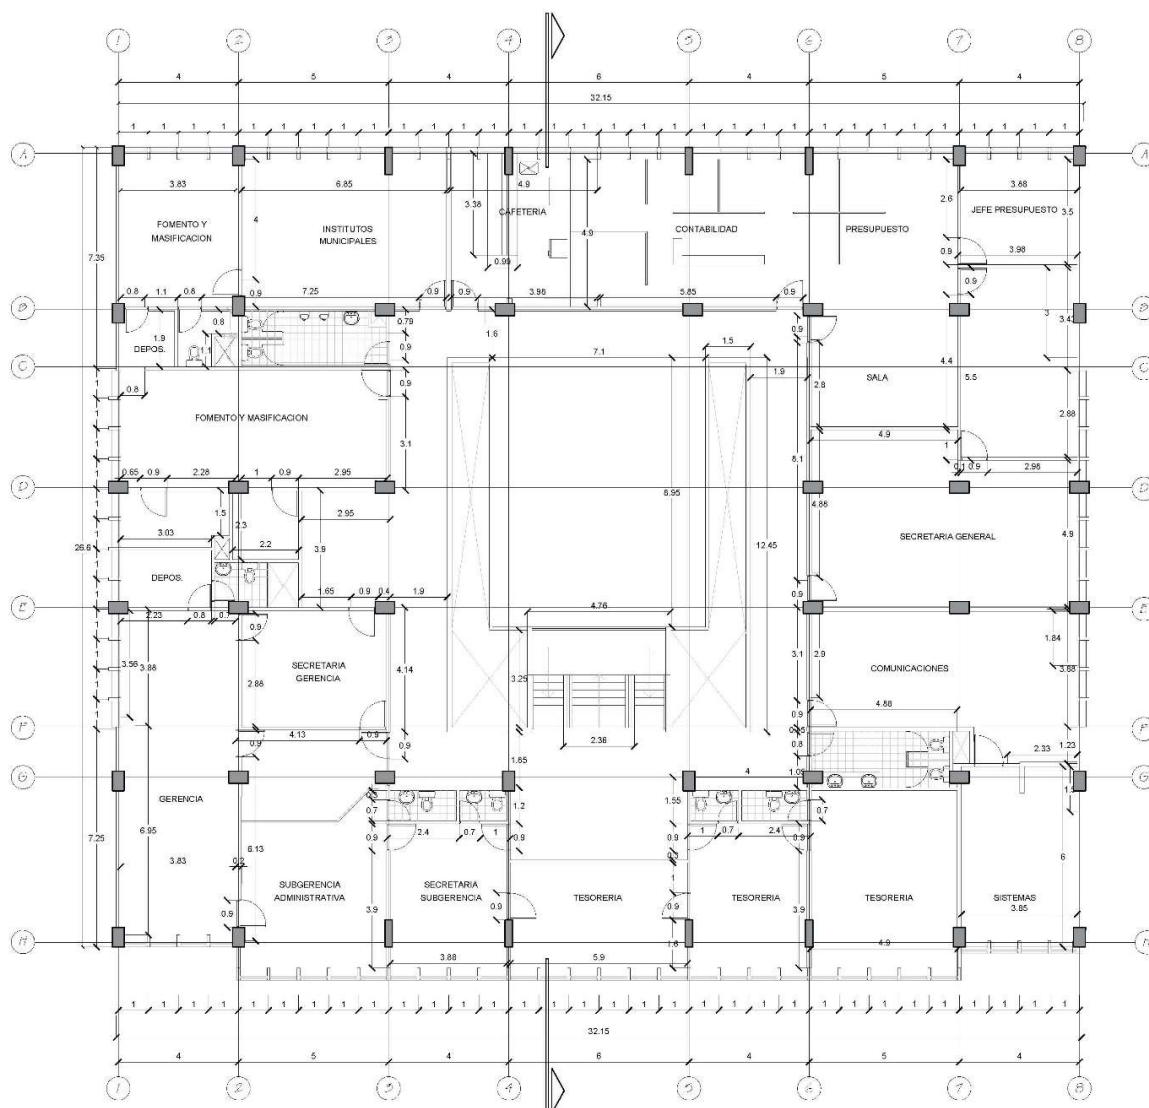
Planos Arquitectónicos – Planta 2do piso.
